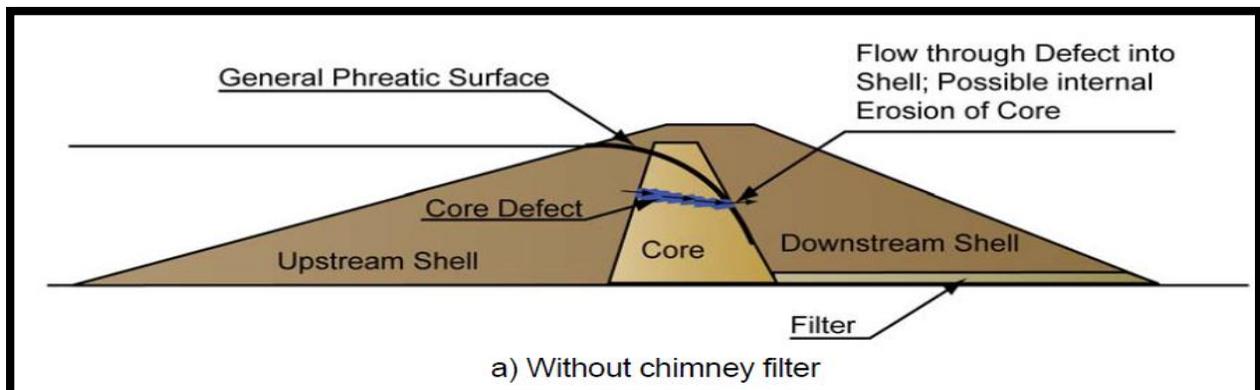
installation d'un drain de fondation (USDA, 2016)
